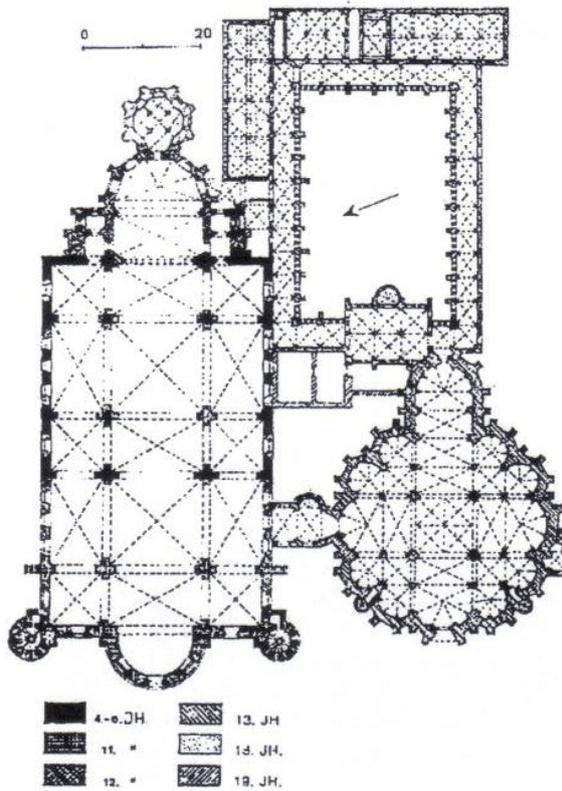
Grundriss von Dom und Liebfrauenkirche (Stadt Trier 97)
